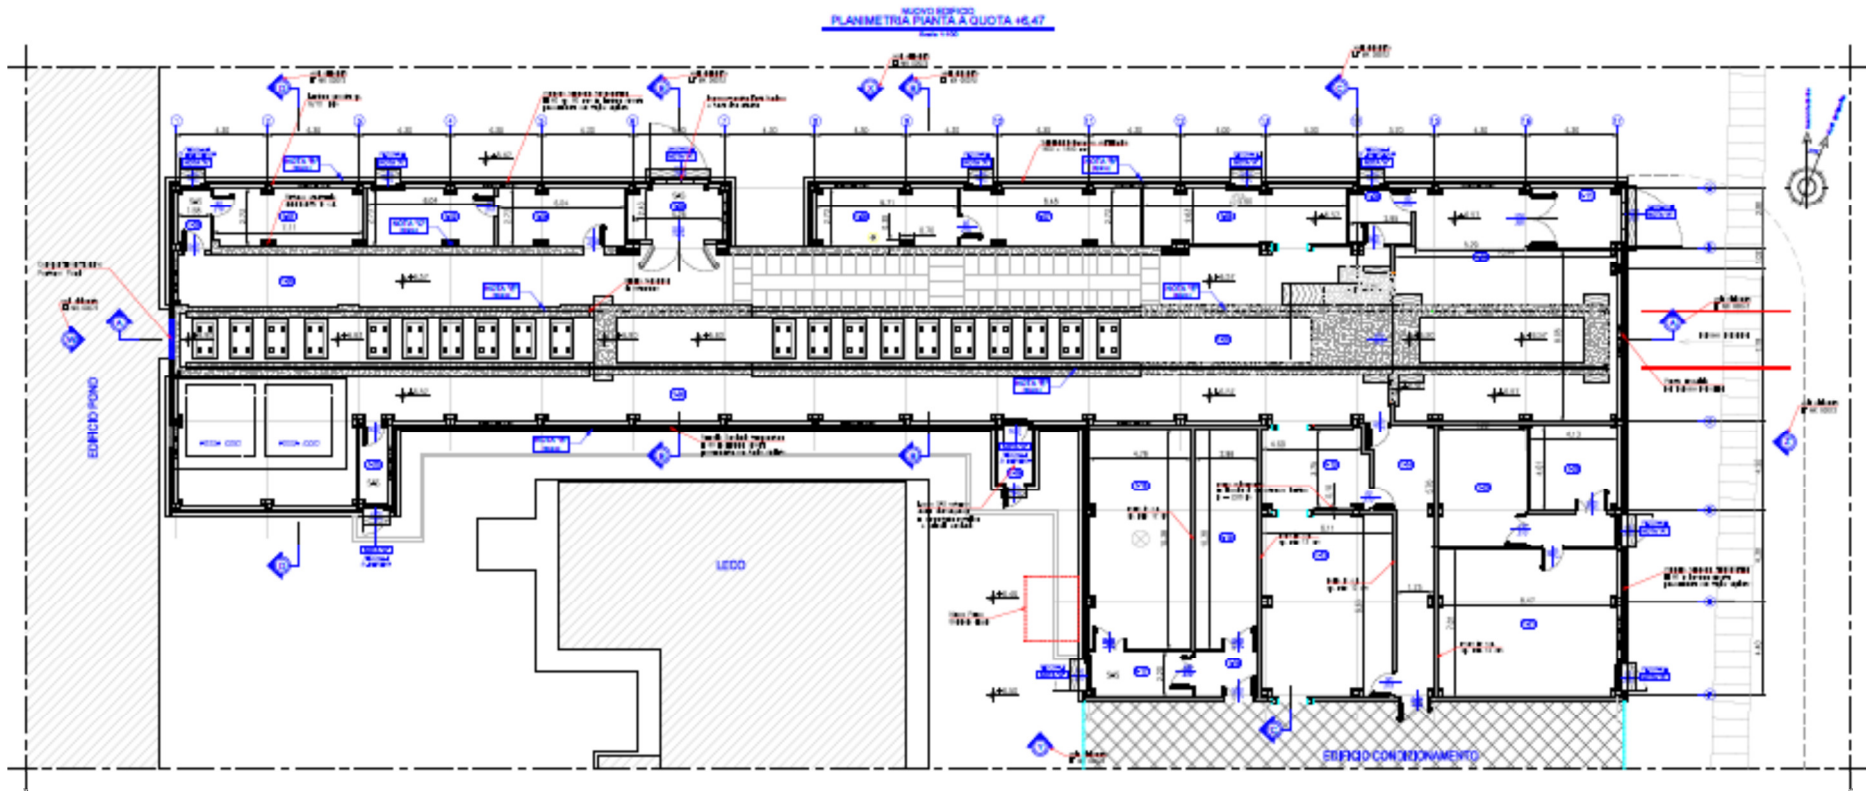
Pianta Edificio Estrazione Cernita e Caratterizzazione
